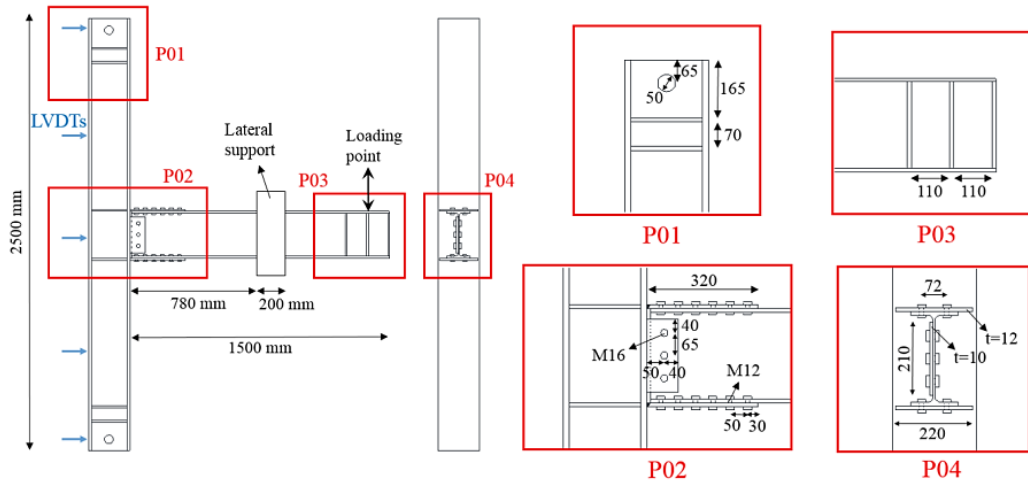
Configuración general, detalles e instrumentación del ensayo de la conexión BFP [20].
